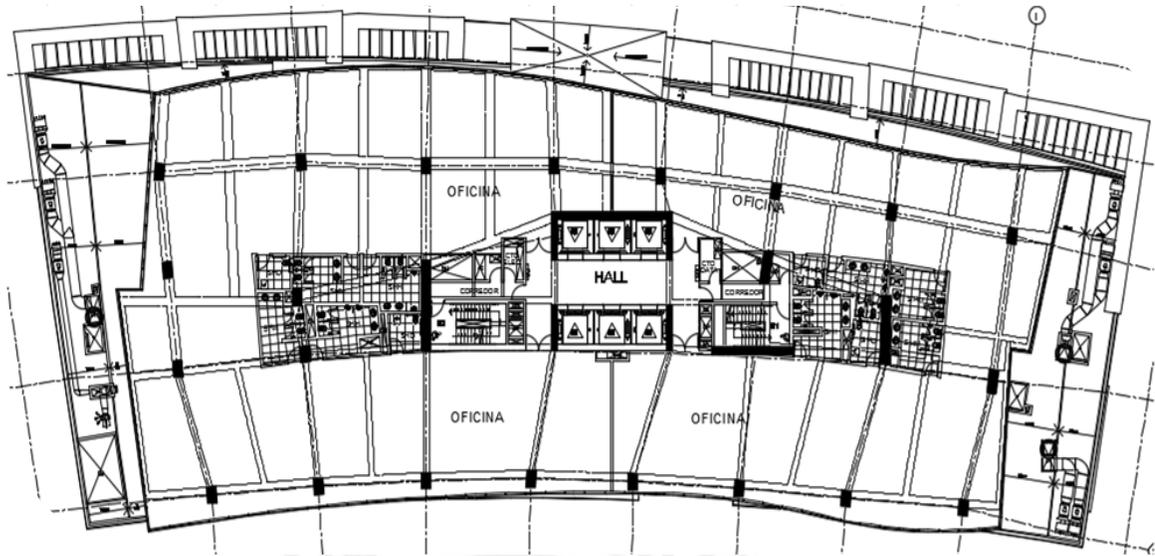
Plano de arquitectura piso típico – Edificio Anexo Torre 3
